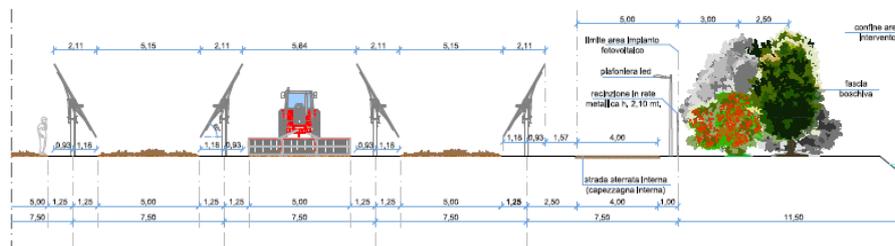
Fasce di coltivazione con i pannelli inclinati in direzioni diverse. Sezione – Stralcio
